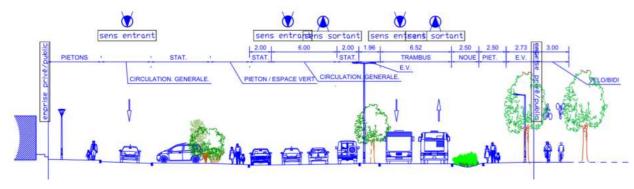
Profil en travers de l'avenue Gaston Berger (Source : Études préalables de la T1)
